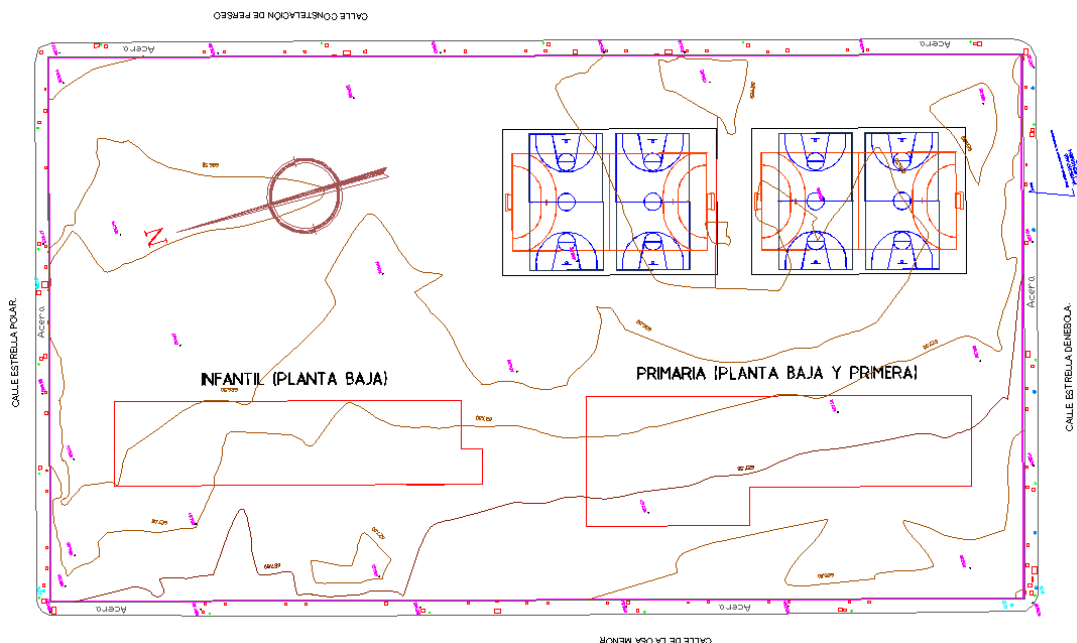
Planta de la parcela con la situación de las edificaciones y pistas deportivas previstas
